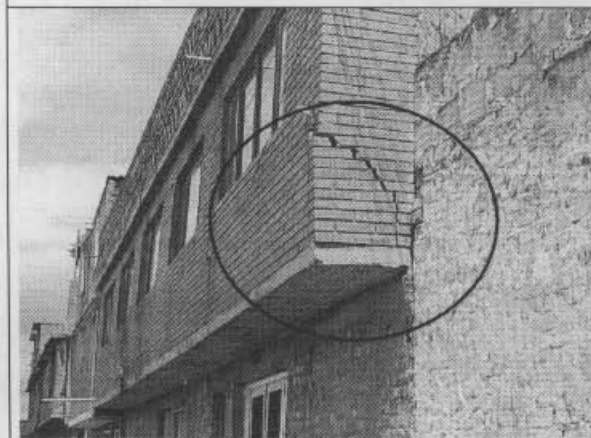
Daño severo en el muro ubicado en el segundo piso del voladizo de fachada.
